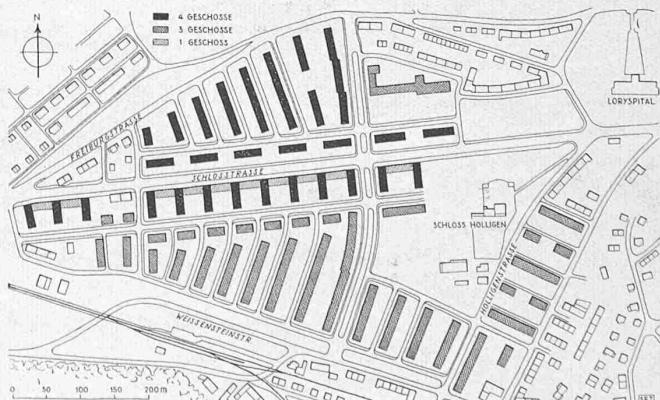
Holligen, Bebauungsplanstudie, Variante A.
